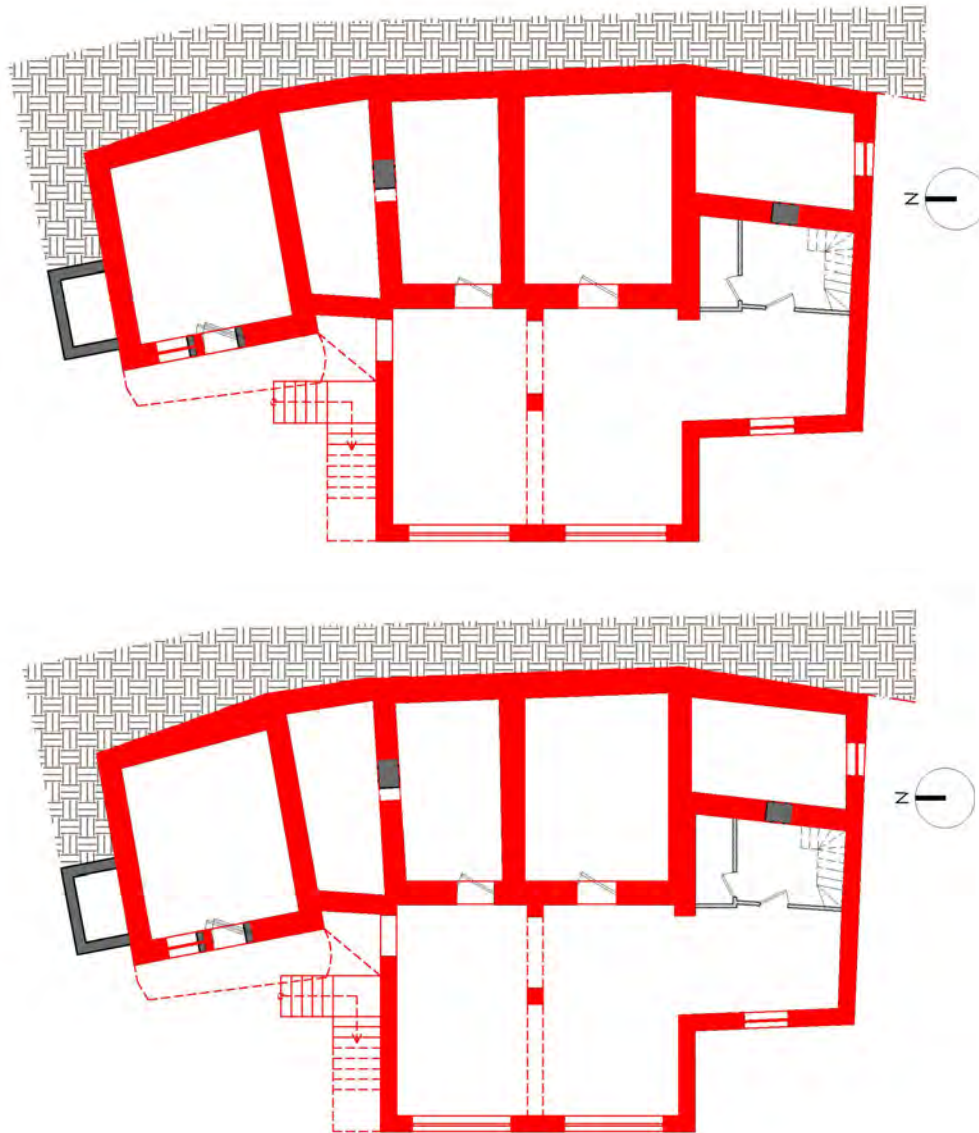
Sovrapposizione planimetria catastale (in rosso) su rilievo stato di fatto - Lotto Uno
